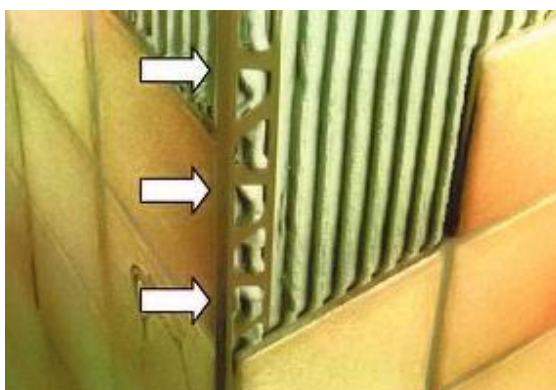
Protecção de um canto saliente de uma parede com perfil prefabricado [30]
